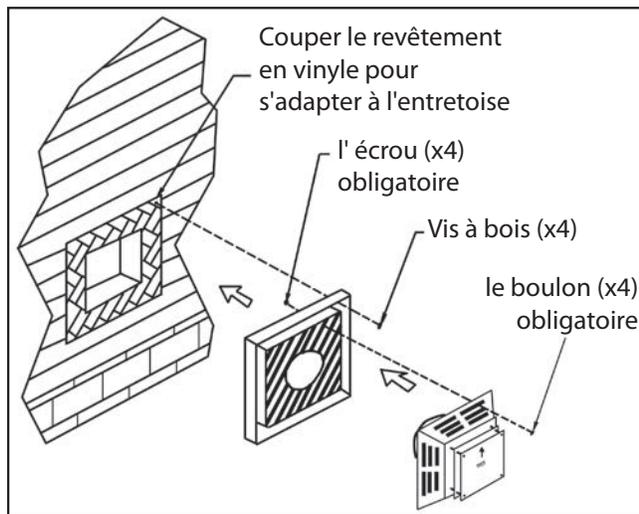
Installation du capuchon d'évent avec un écarteur de parement en vinyle.
